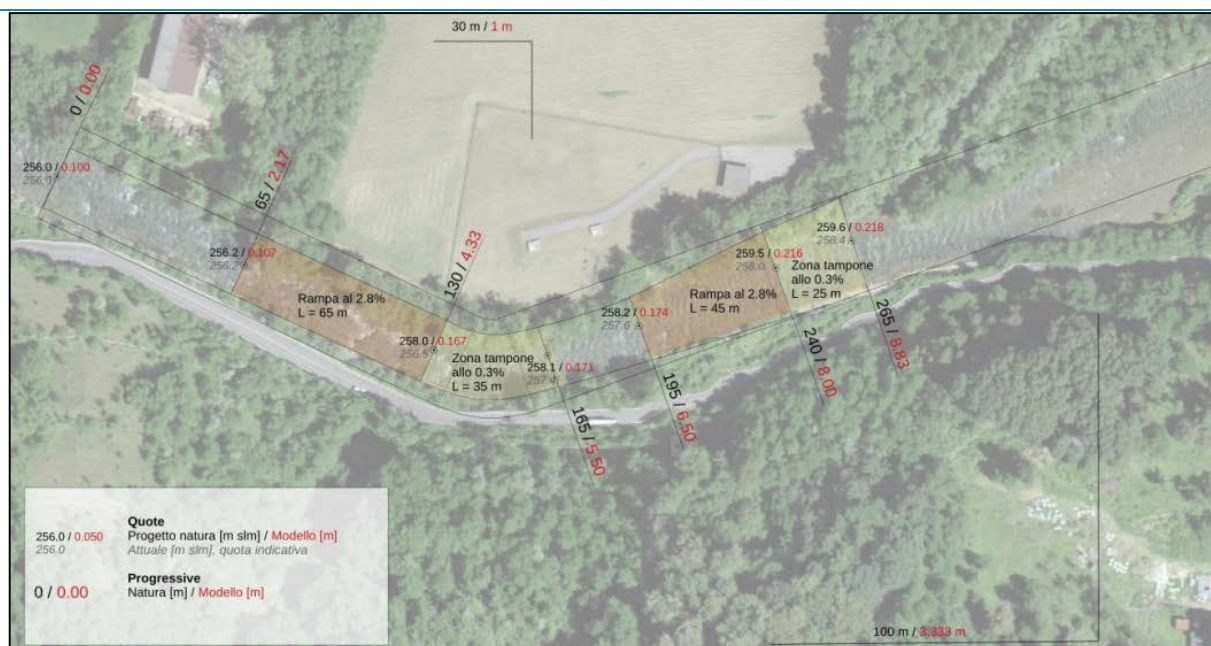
Piano di ubicazione delle rampe di fondo fornito da Laboratorio 3D
